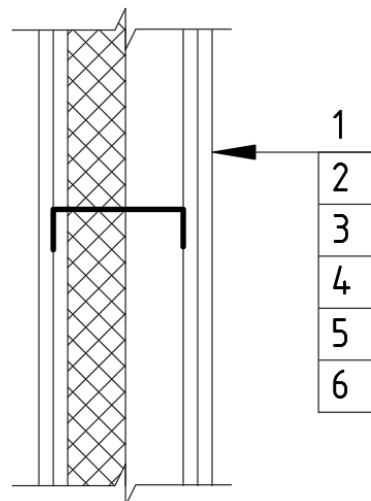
Схема к расчету звукоизоляции перегородки
